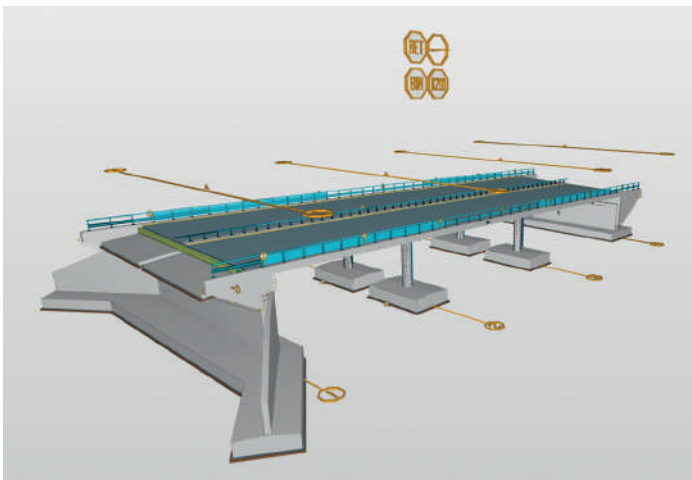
Ponte Raunesteinsli – Modelo BIM da estrutura. Raunesteinsli Bridge – BIM Model of the structure.
